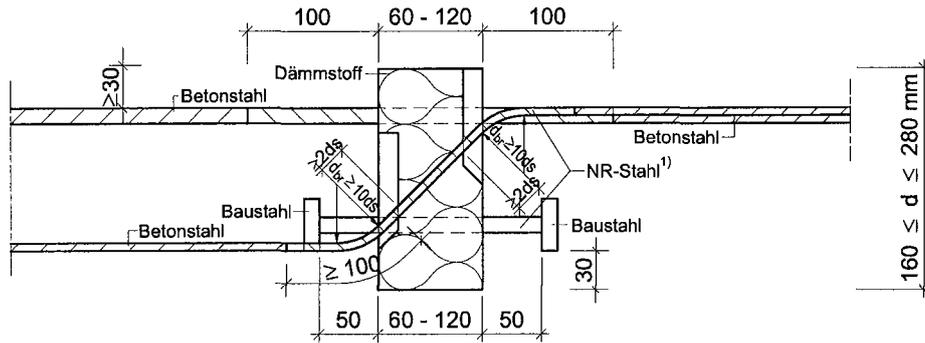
Schöck Isokorb Typ K <sup>1)</sup>
